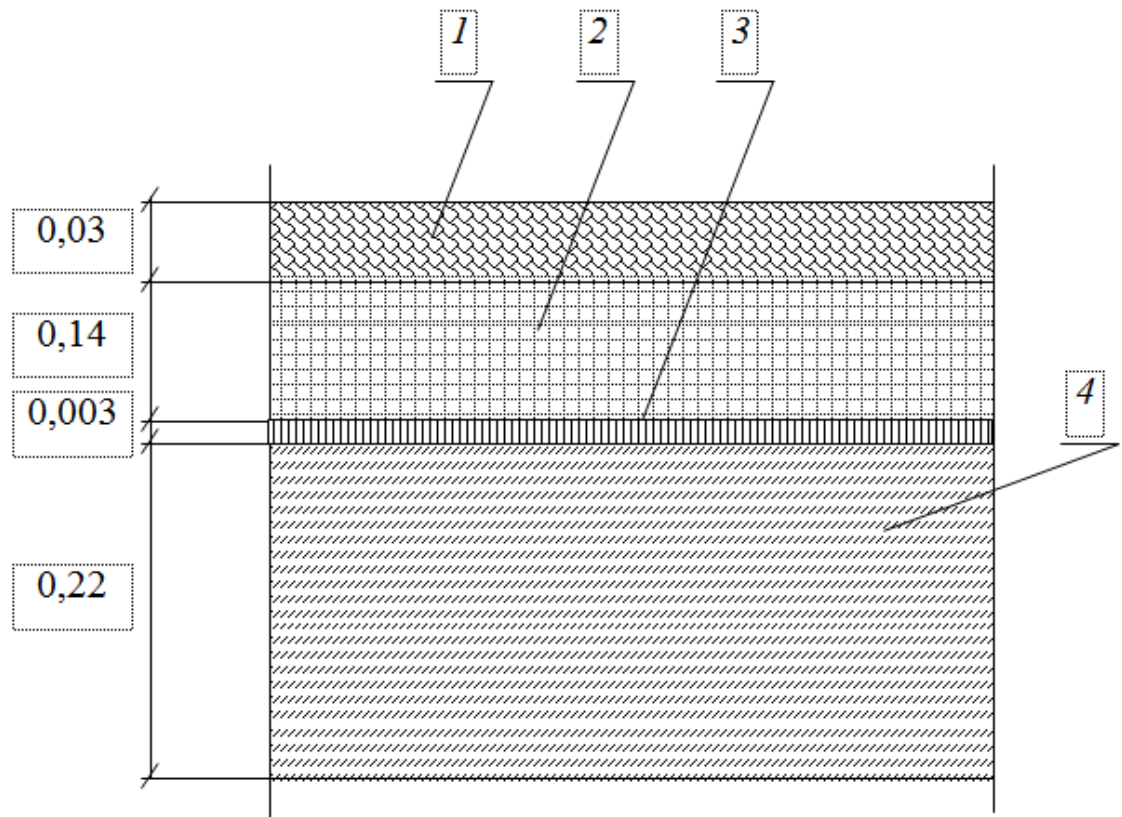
Схема переkritтя горища: 1 – цементно-піщана стяжка 2 – гравій шунгізовий; 3 – руберойд; 4 – залізобетонна плита
